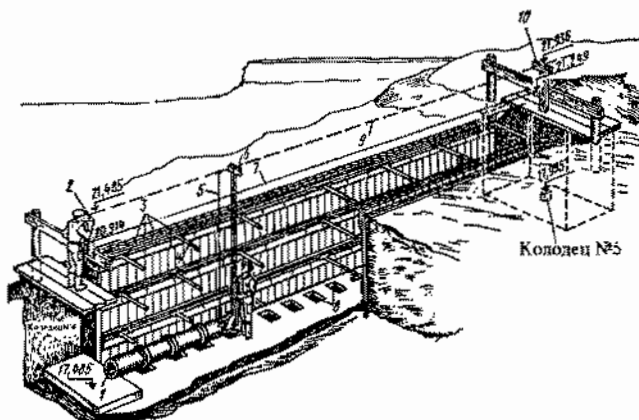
Схема укладки трубопровода по заданному направлению и уклону: 1 - укладываемый трубопровод; 2 - пришивная визирка №1; 3 - крепление траншеи; 4 - нивентарные распорки (струбины); 5 - отвес; 6 - ходовая визирка; 7 - проволока (причалка); 8 - приямки для заделки растресков; 9 - линия визирования; 10 - пришивная визирка №2
